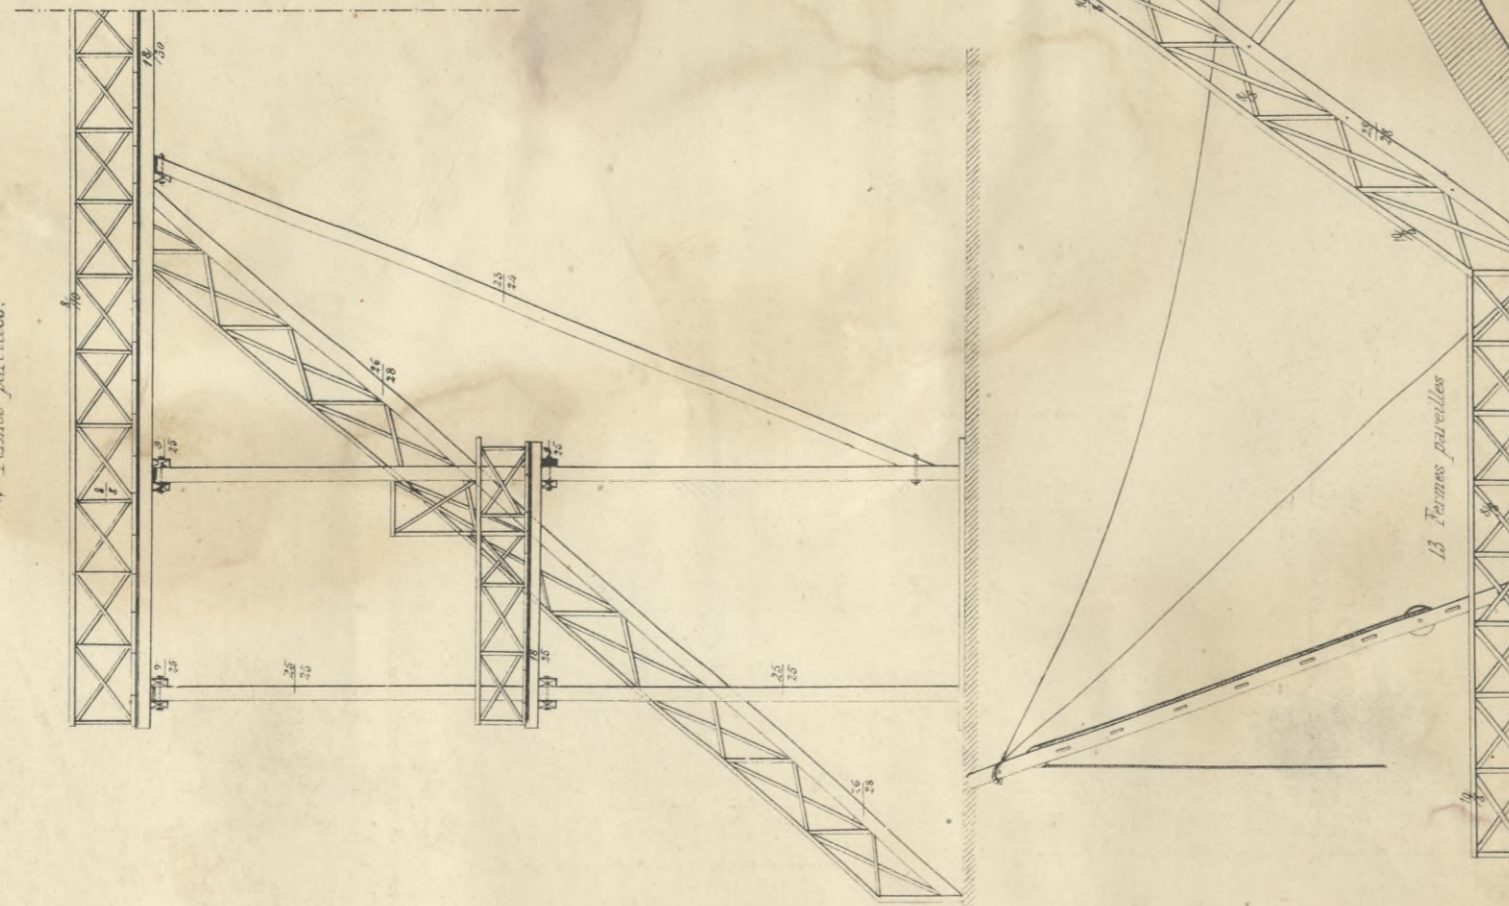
Coupe Verticale (à 2,01 pour 1,00) Fig. 2. — Elevation.
